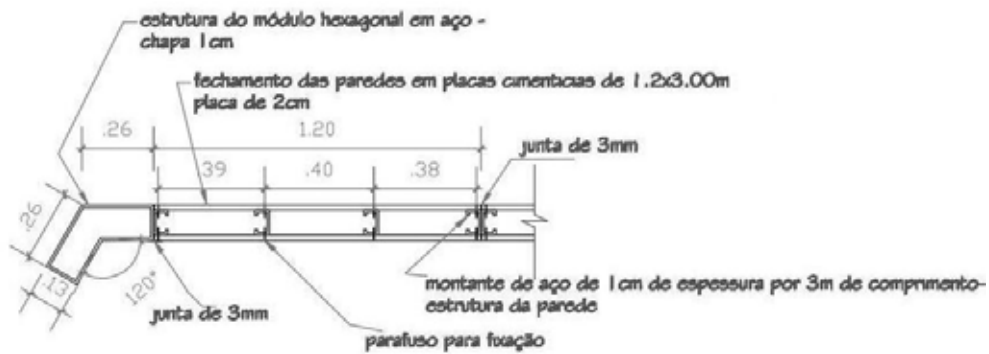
Perfil metálico estrutural do sistema *steel framing*. Fonte: Projeto Arquitetônico V – Prancha de detalhamento – Bruna van der Laan.
